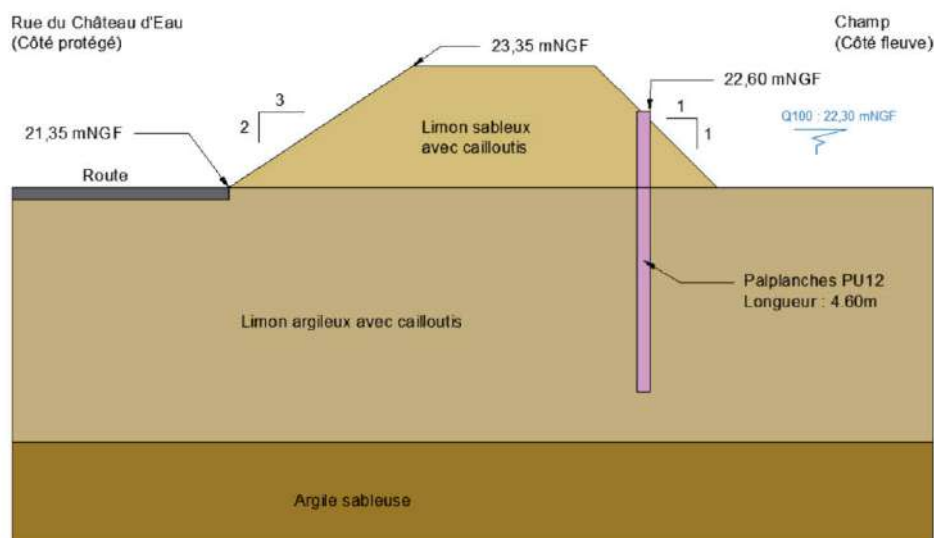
COUPE TYPE - CONFORTEMENT DE LA DIGUE ACTUELLE AVEC DES PALPLANCHES
